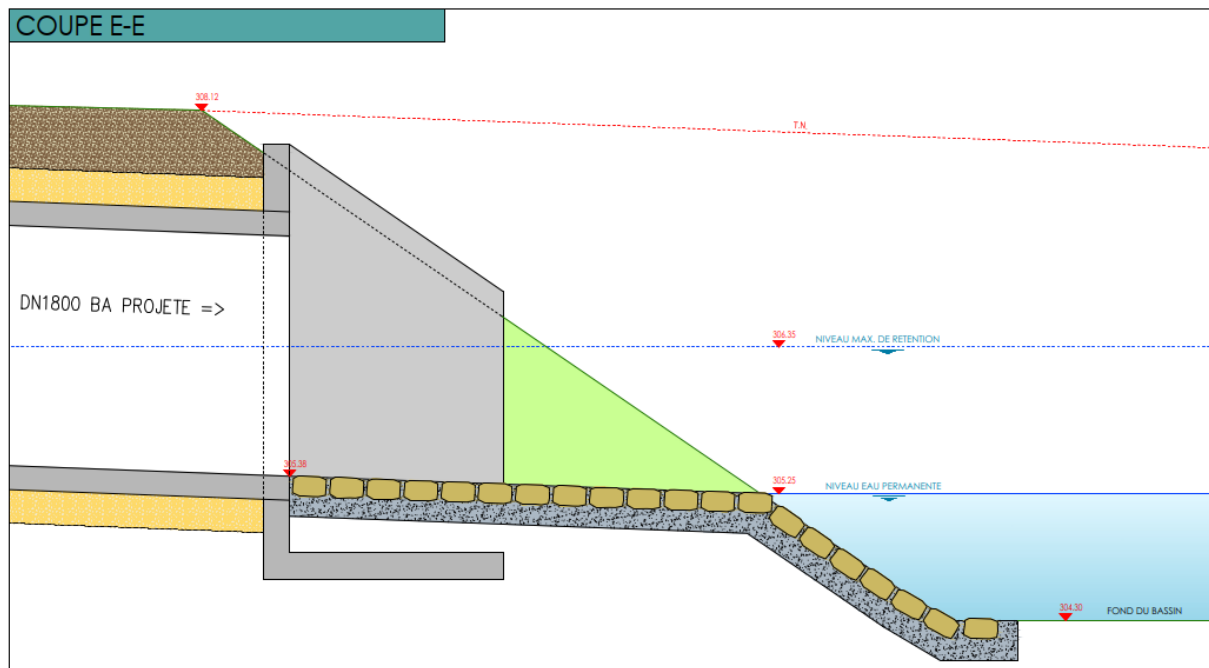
Auszug aus dem veralteten Plan „Concept d'assainissement - Vues en plan et coupes ouvrages“ (Quelle: Luxplan S.A. Stand 06/2020): Querschnitt durch die Einleitungskonstruktion in das Becken (Schnitt EE, vgl. Abb. 24)
